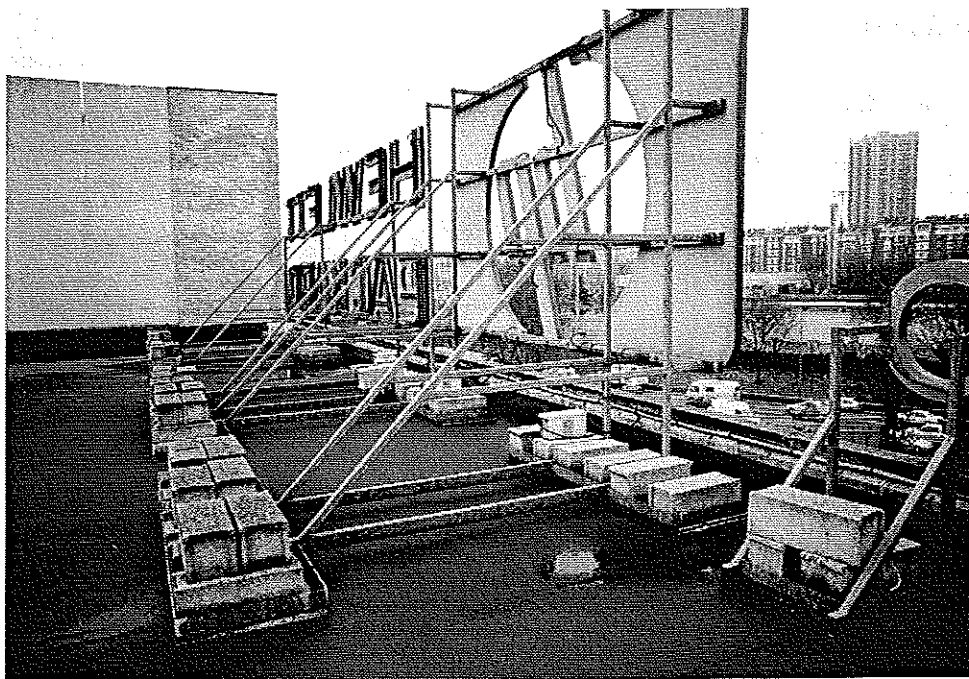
Disposition « provisoire » d'installation de panneaux publicitaires dont la stabilité est assurée par des lestages par blocs de béton. Ce type d'ouvrage est particulièrement vulnérable en cas de fortes tempêtes, et dangereux pour le revêtement d'étanchéité. © J. Putatti
